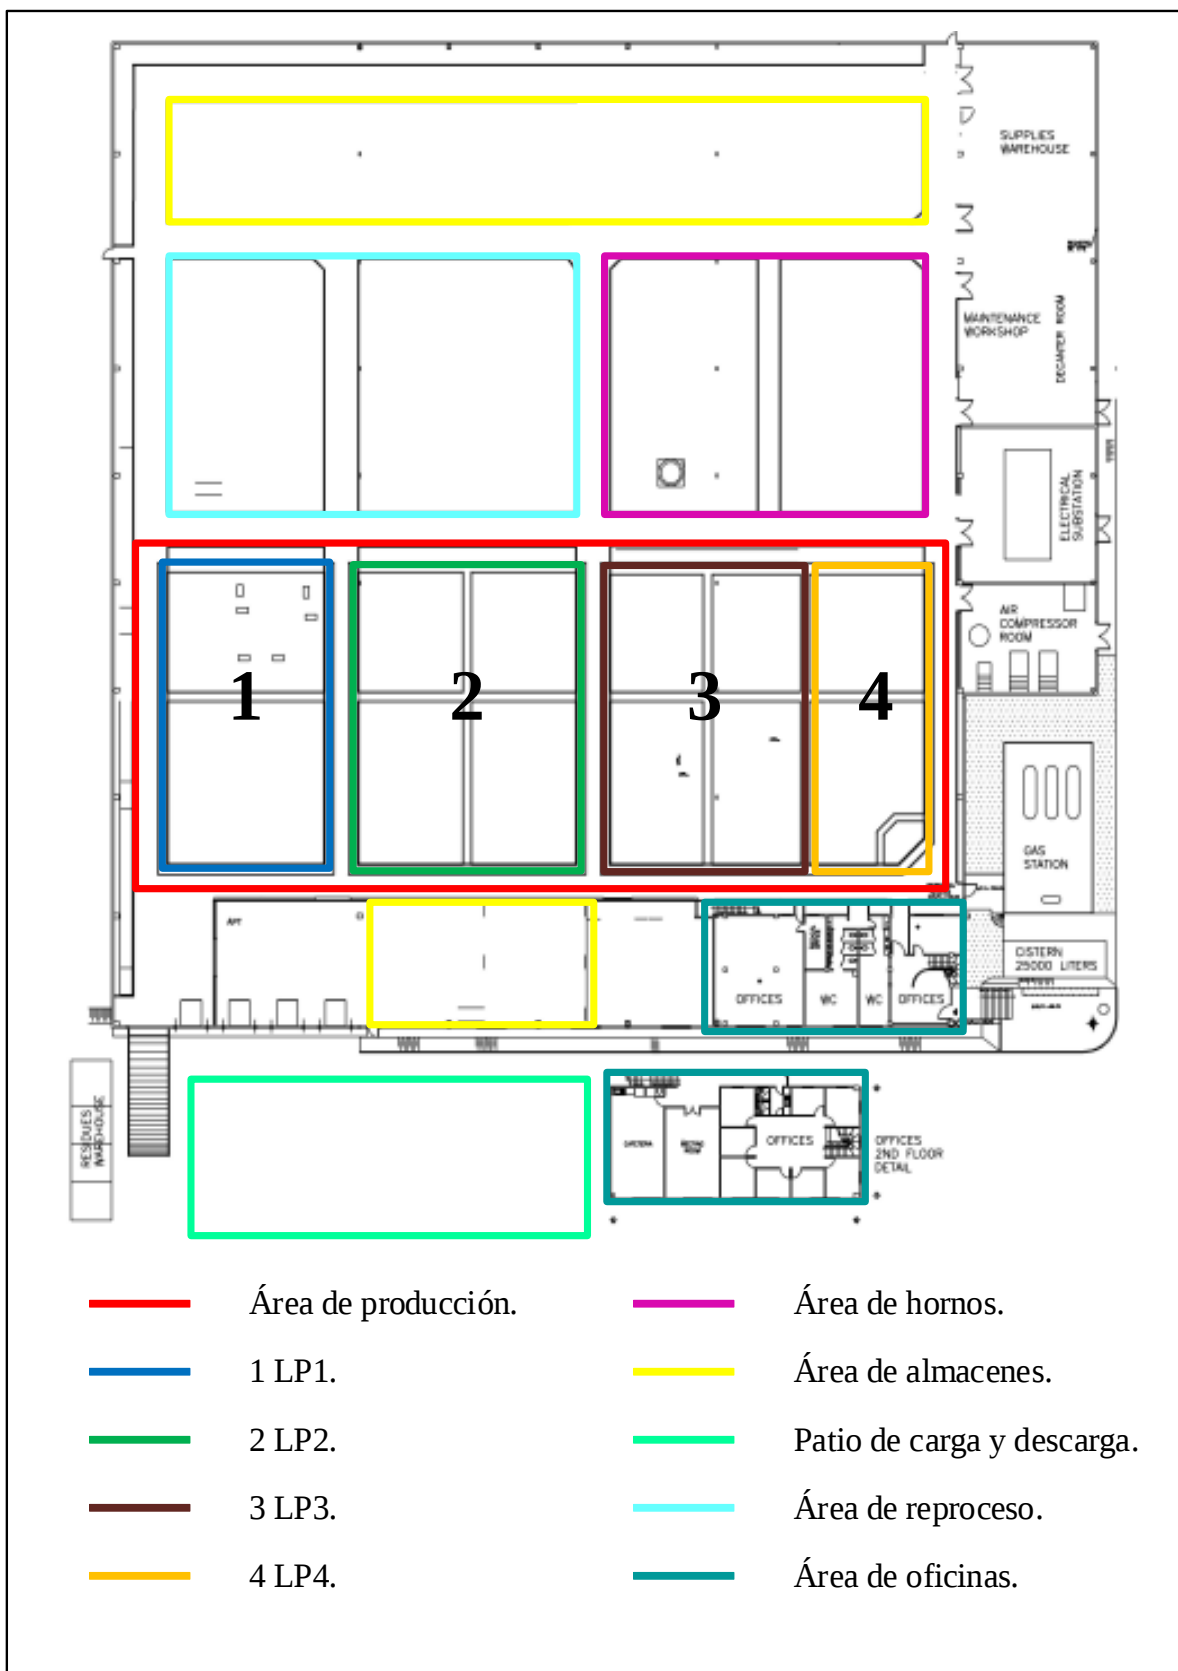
Distribución de planta (Fuente: elaboración propia).
